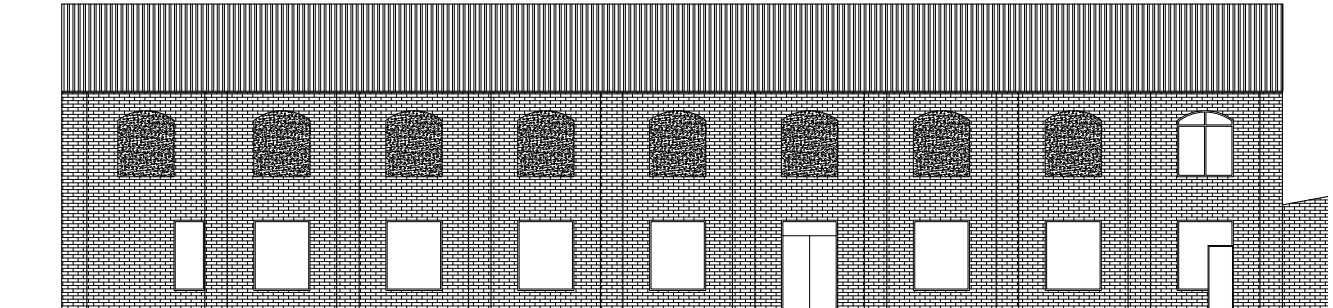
Levantamiento planimetrico situación actual Galpón 7 Chucre Manzur. S/ escala.
